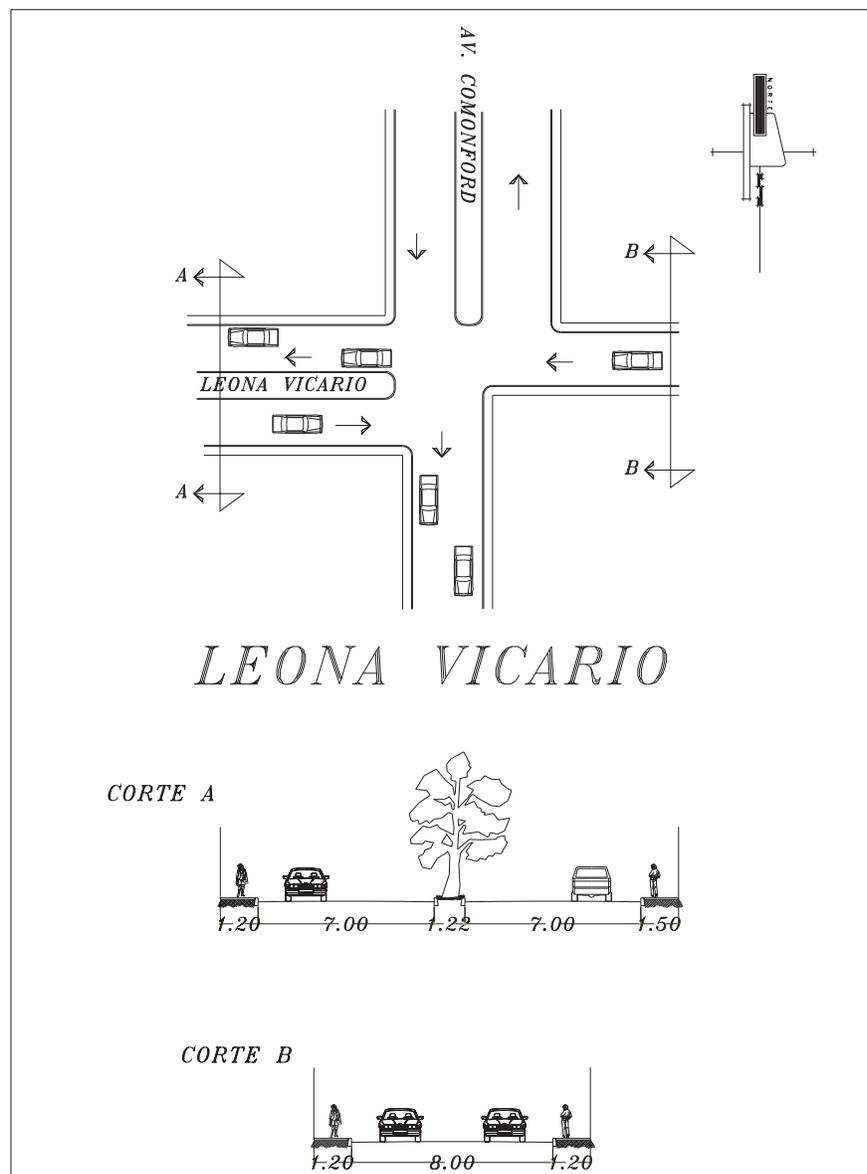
Corte transversal de la Av. Leona Vicario.
